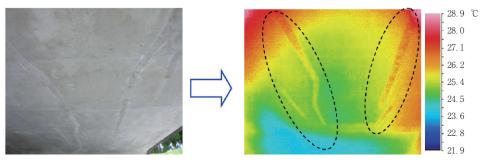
東側下面ひび割れ補修箇所の赤外線写真
